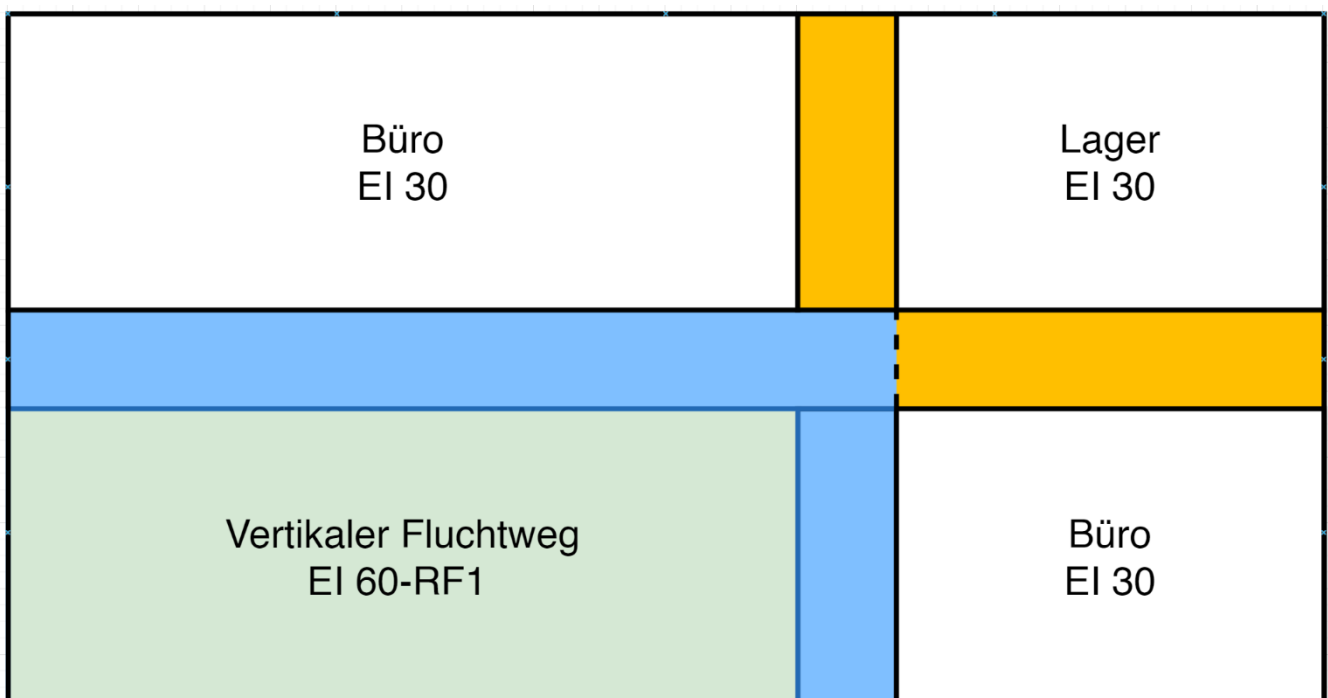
, vereinfachte Darstellung Grundriss, eigene Abbildung
